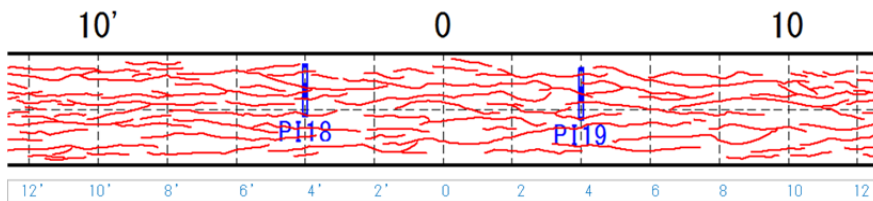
G3 桁下面橋軸方向ひび割れの計測位置
